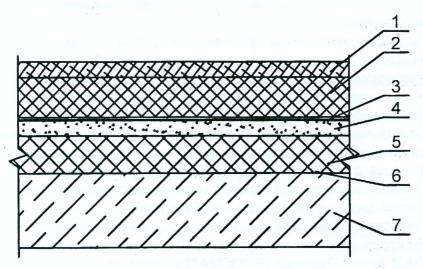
Конструкция инверсионной кровли, при выполнении ремонтных работ эксплуатируемых совмещенных кровель:
